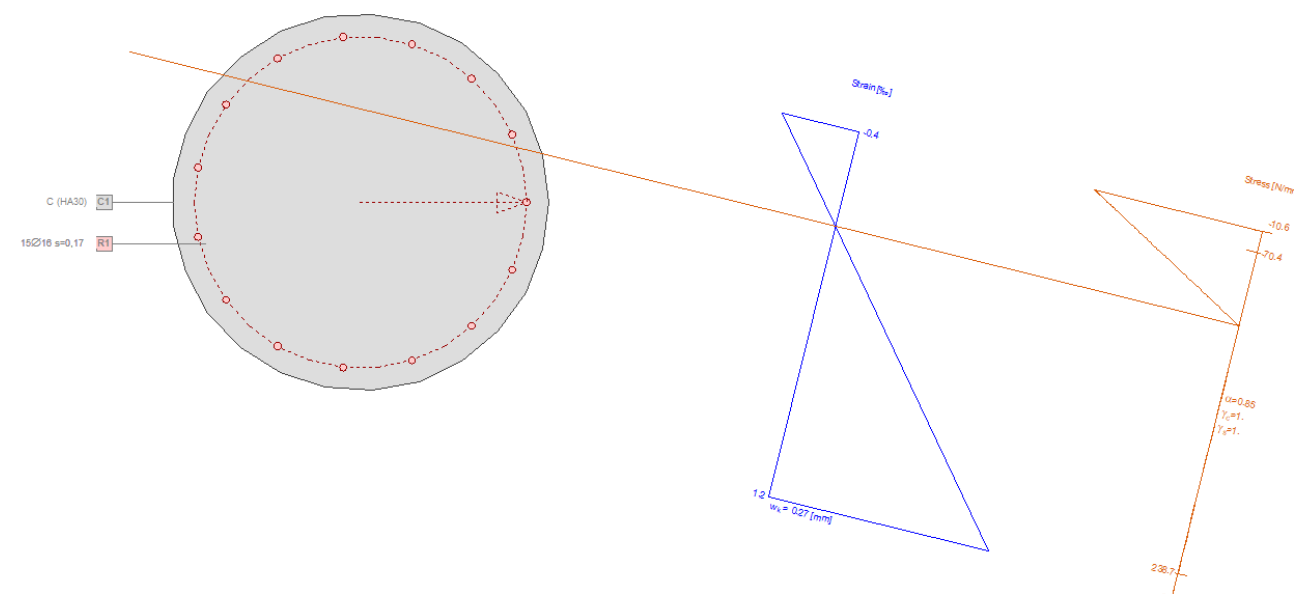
Càlcul de fissuració màxima dels pilons de la piles 3 i 7
